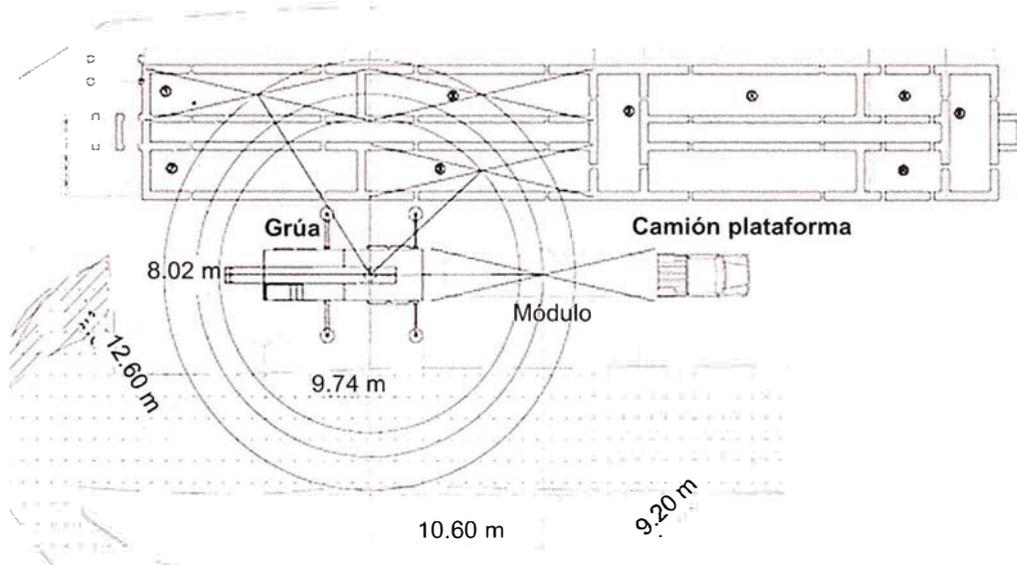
Vista en planta para la elaboración del plan rigging
